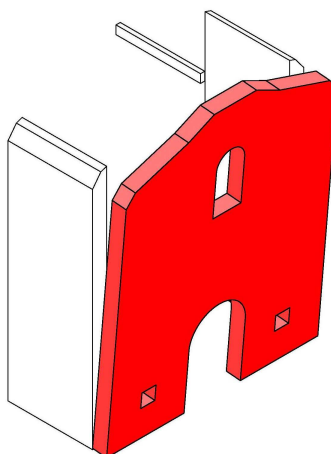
Interpretación del mecanismo. Desplome de fachada con grietas verticales.
